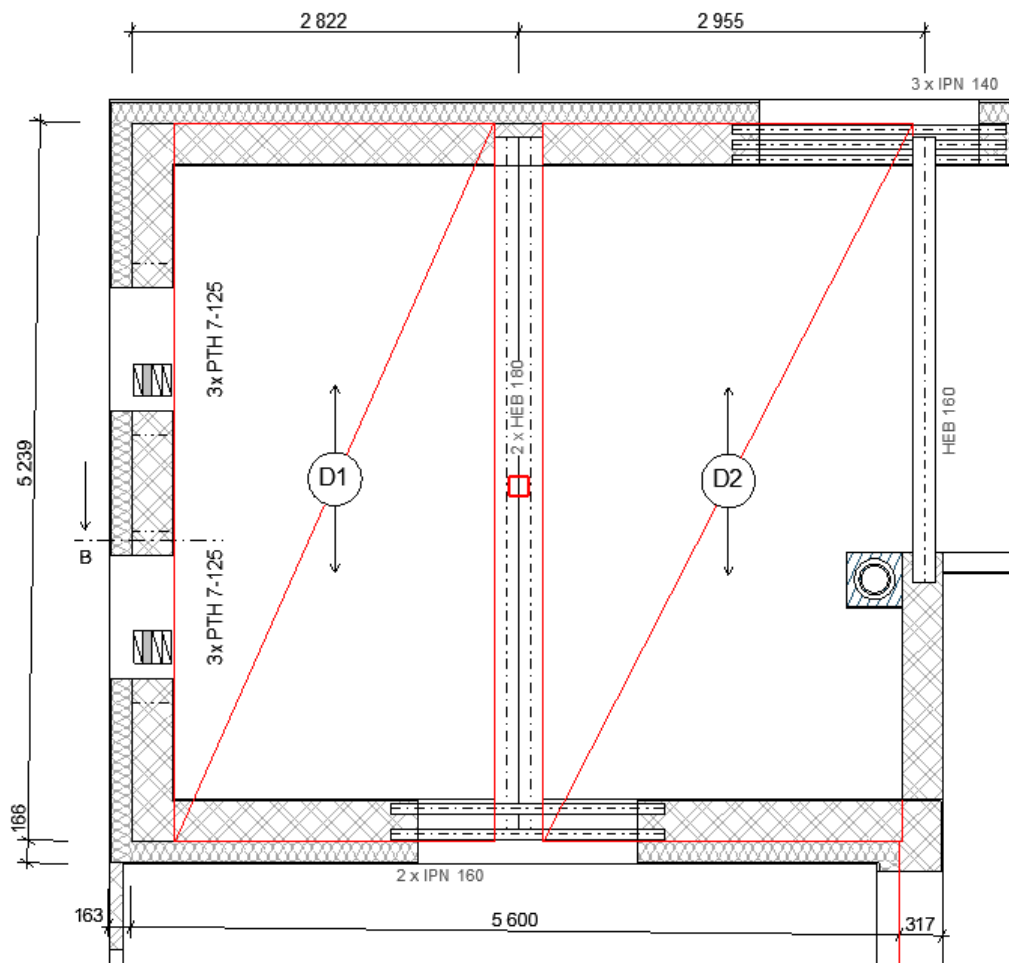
původně navržená stropní konstrukce – půdorys
